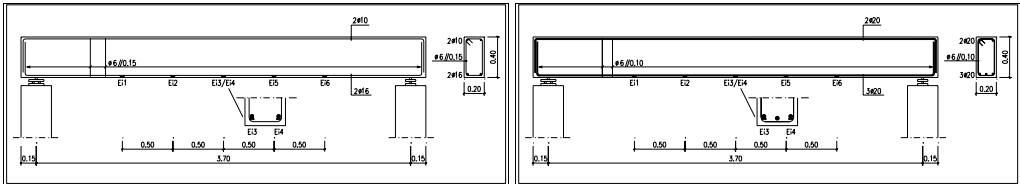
Armadura ordinária das vigas A11, A12, A14, A31, A32, A33 e A34 e A21 [1].
